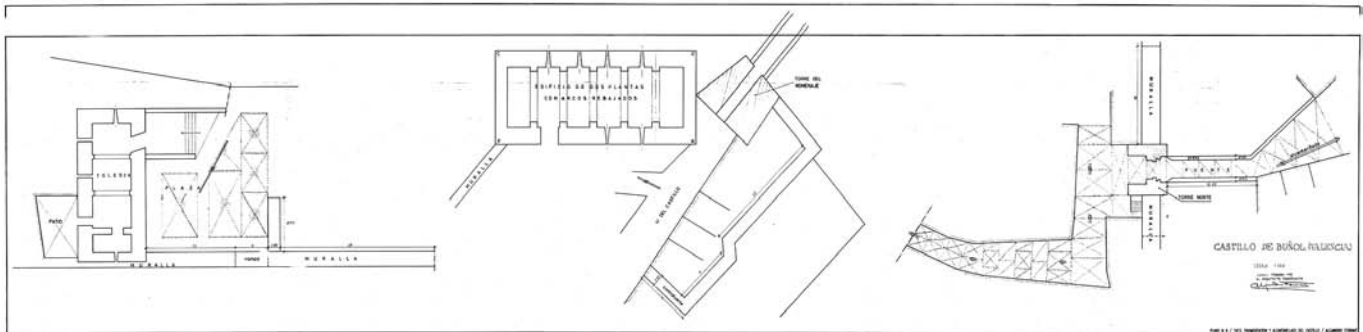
1973. Pavimentación del Castillo. Ferrant
